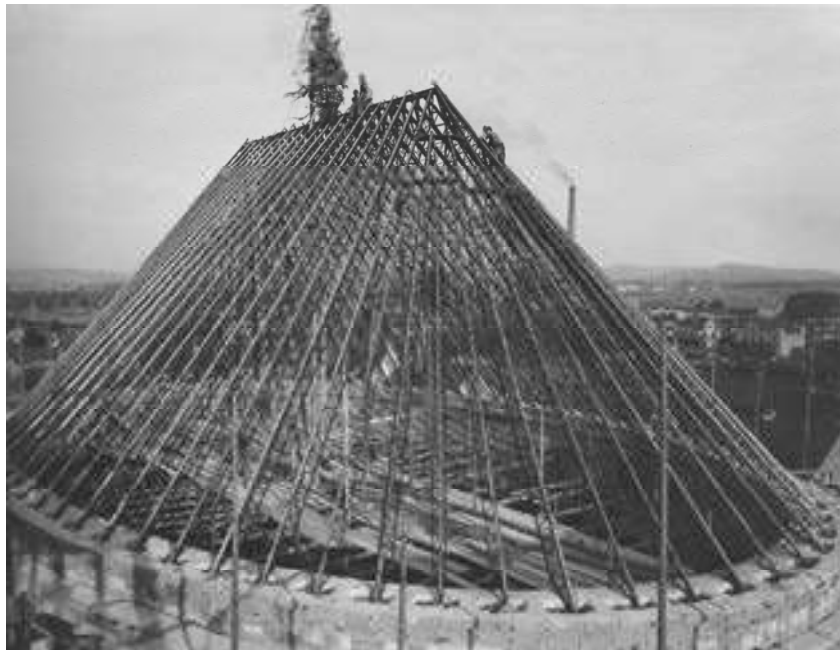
Ein Kirchendachstuhl mit V-Sparren 1952 (aus S3-F3-M2)
